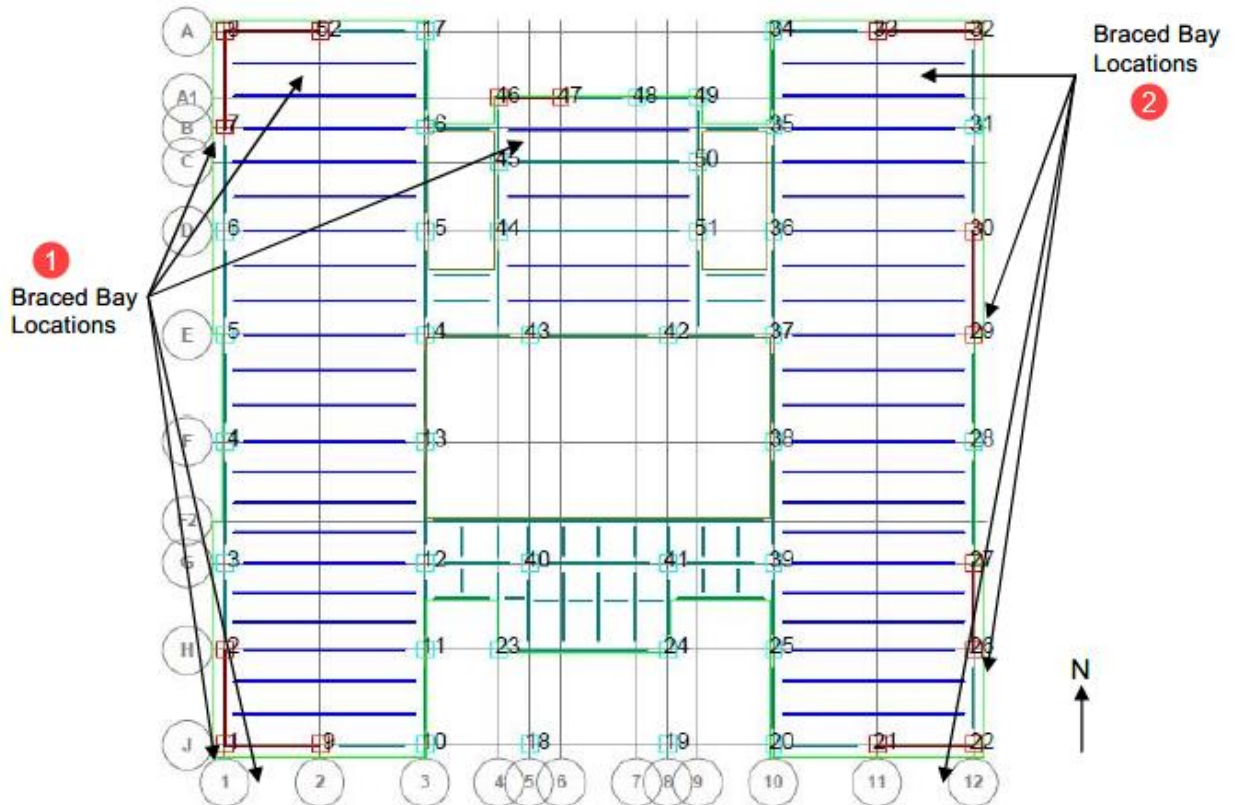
Emplacement des poteaux (deuxième étage et toit)
